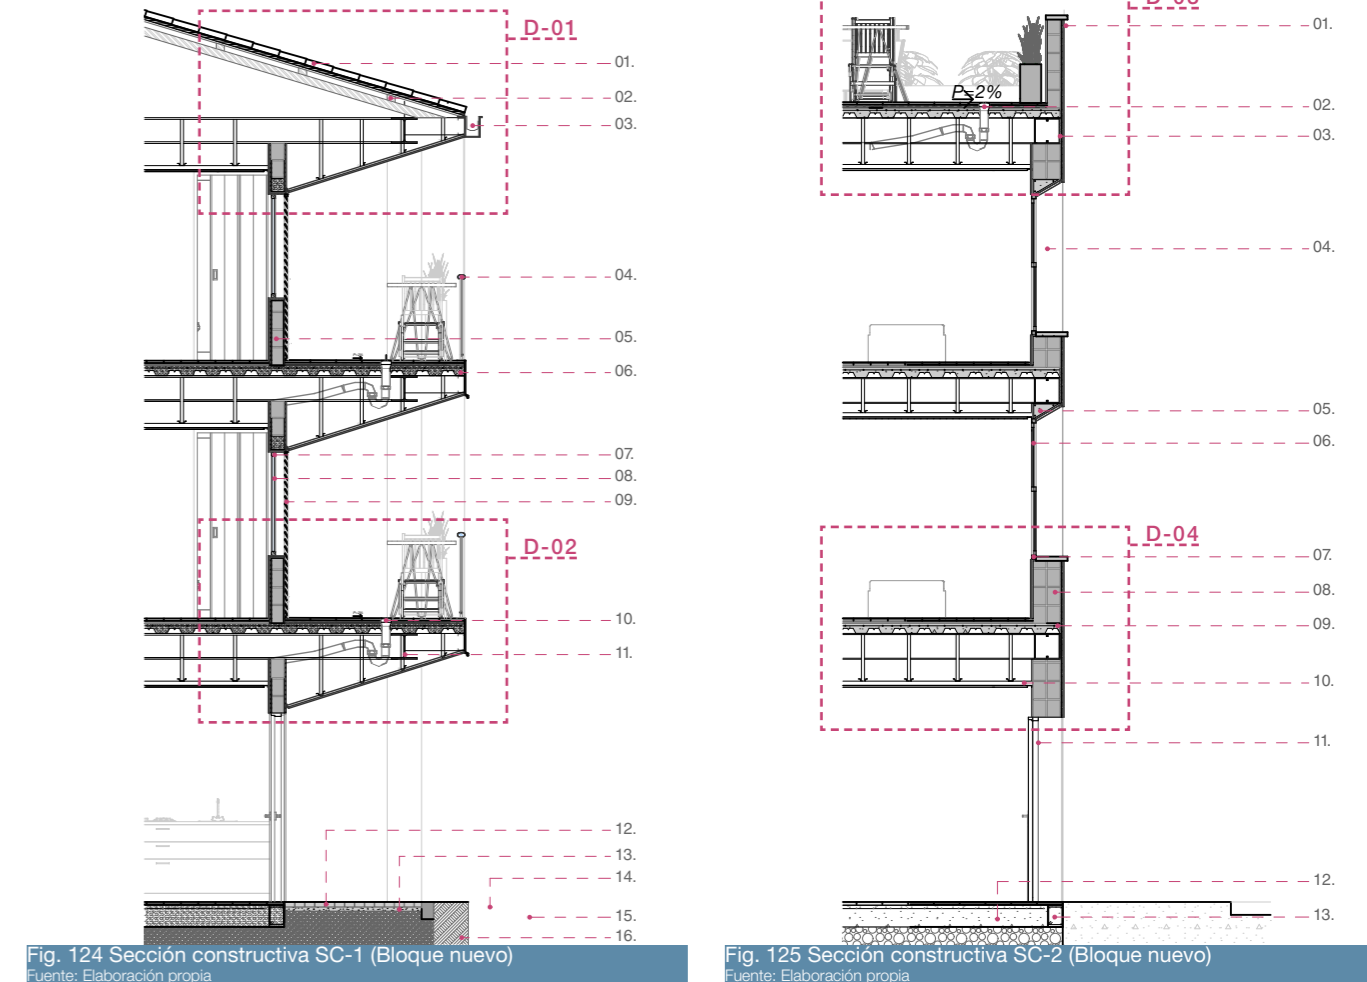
Sección constructiva SC-1 (Bloque nuevo)
